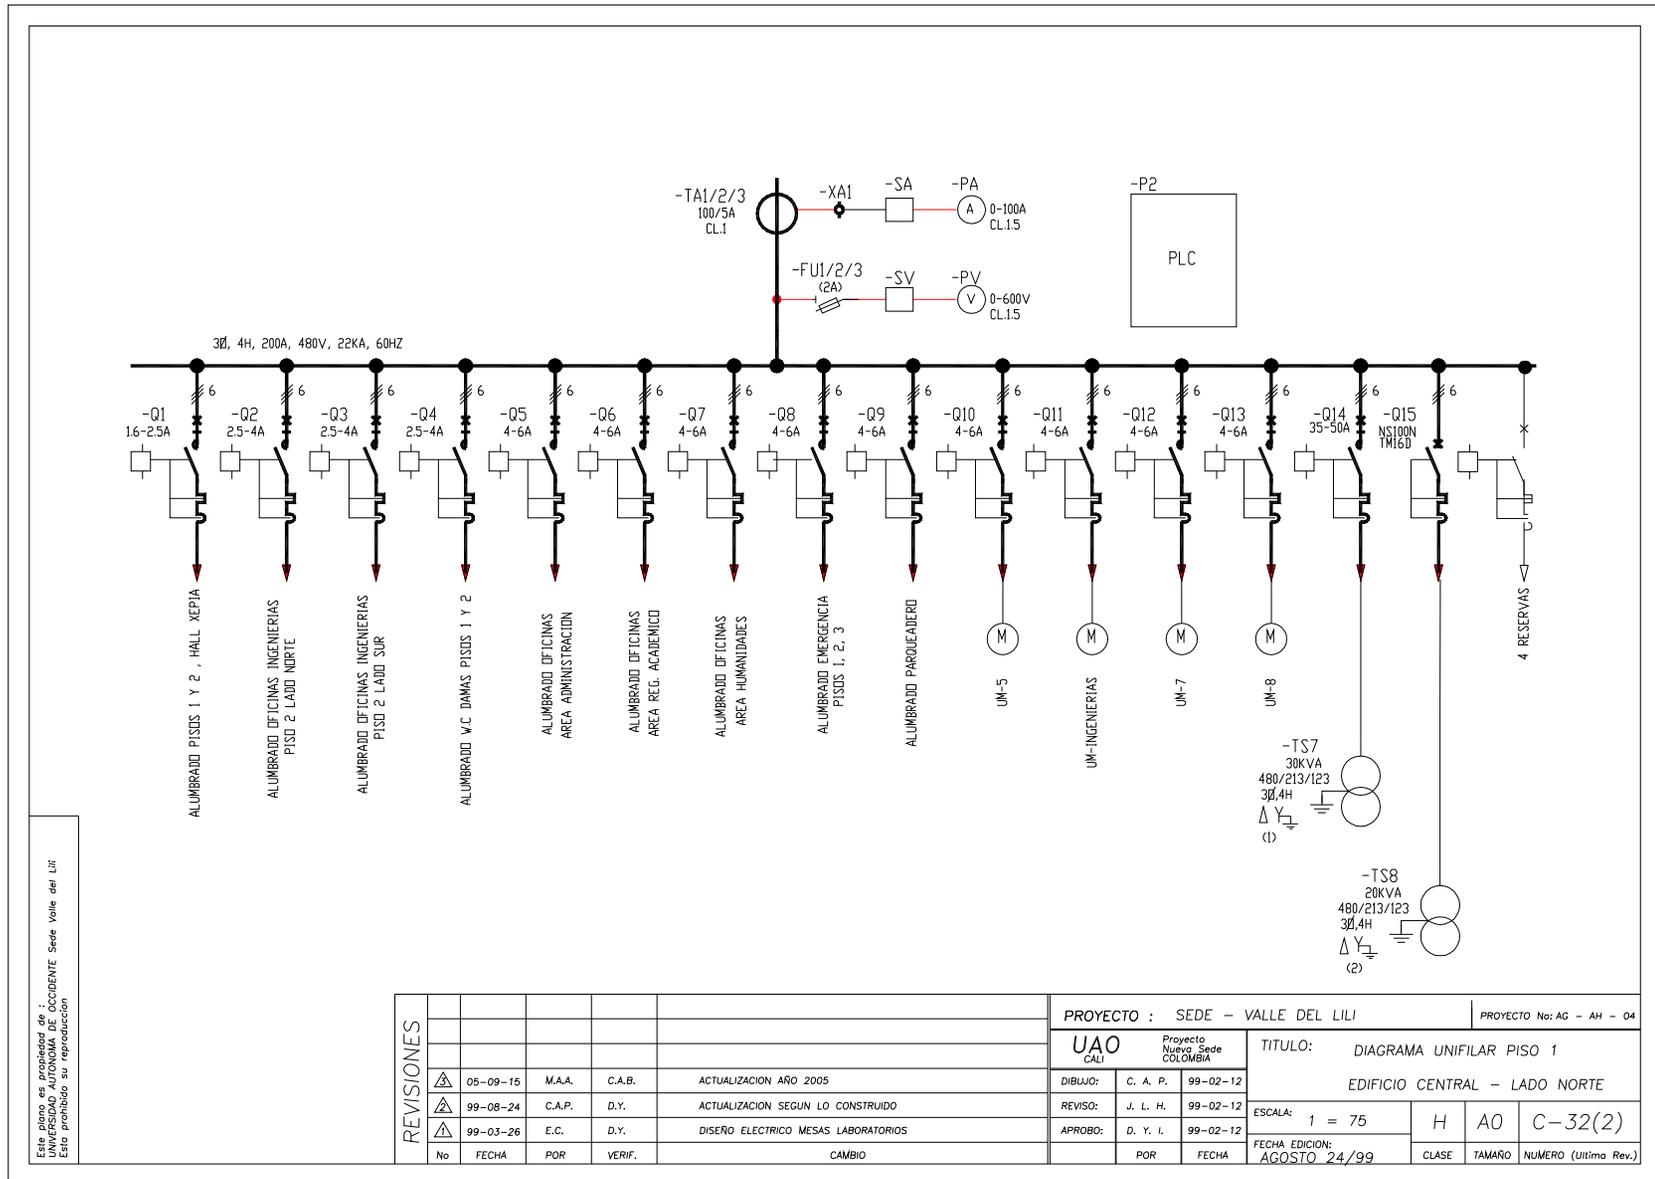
Tablero de Distribución Ed. Central piso1 lado norte
